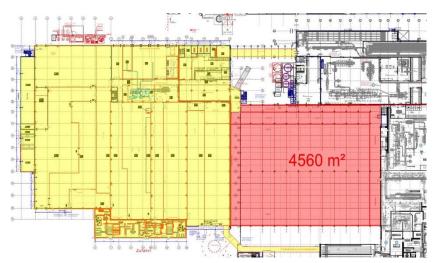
Neubauten (Quelle: Junker-Architekten, Grundriss: EG-Ü-Z-250710)
